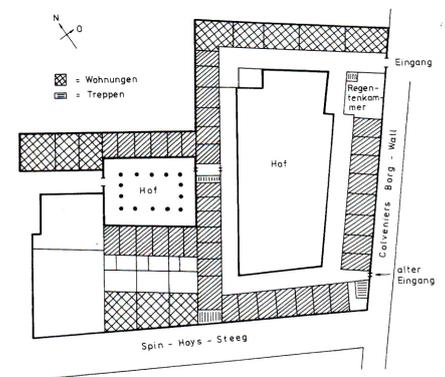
Grundriss Het Doll - Huys Absterdam
